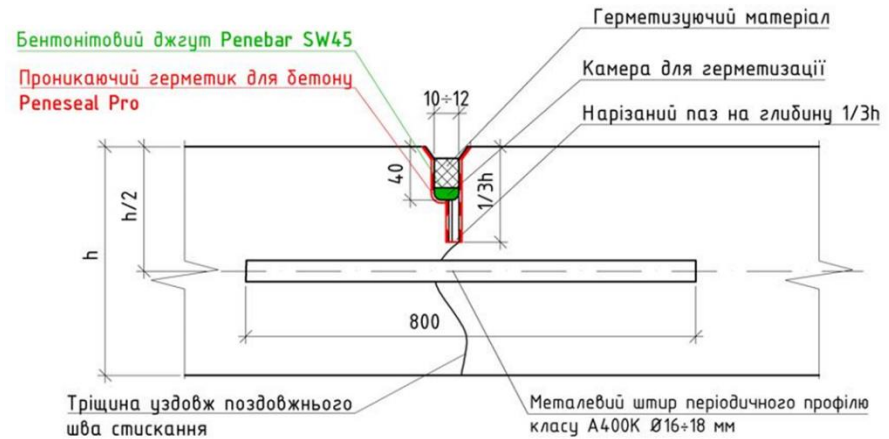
Конструктивна схема поздовжнього шва стискання в цементобетонному покритті
